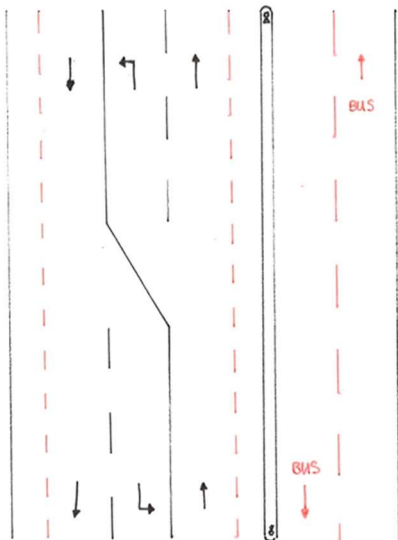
Schematisches Querschnitts-Prinzip Pilatusstrasse (Umsetzung mit Baumbestand zu prüfen)
